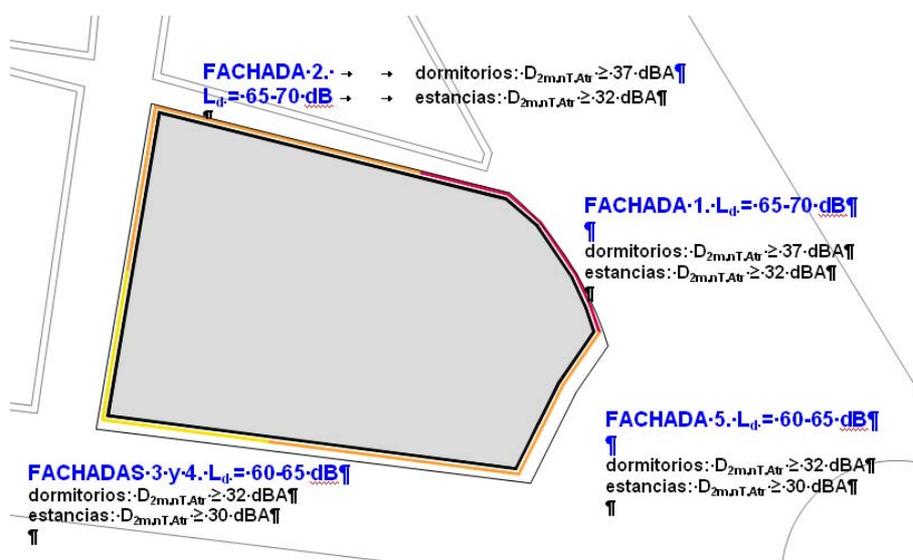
Niveles de ruido de cada fachada y aislamiento acústico necesario en cada fachada
